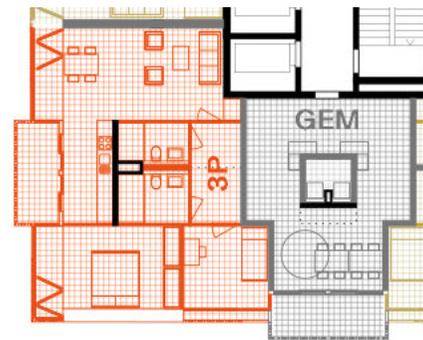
Grundriss Gemeinschaftsraum zwischen Wohnungen | 03 Arch. GmbH (München)
